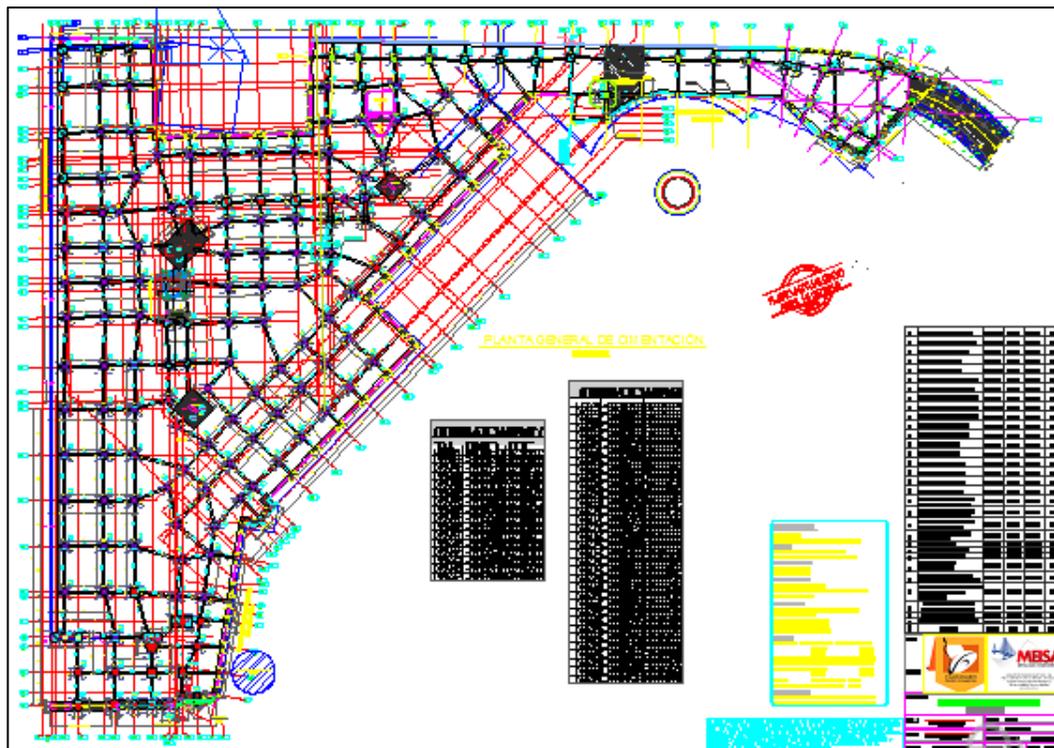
Planta de la estructura de cimentación. Fuente: Departamento de diseño Metálicas e Ingeniería S.A.
